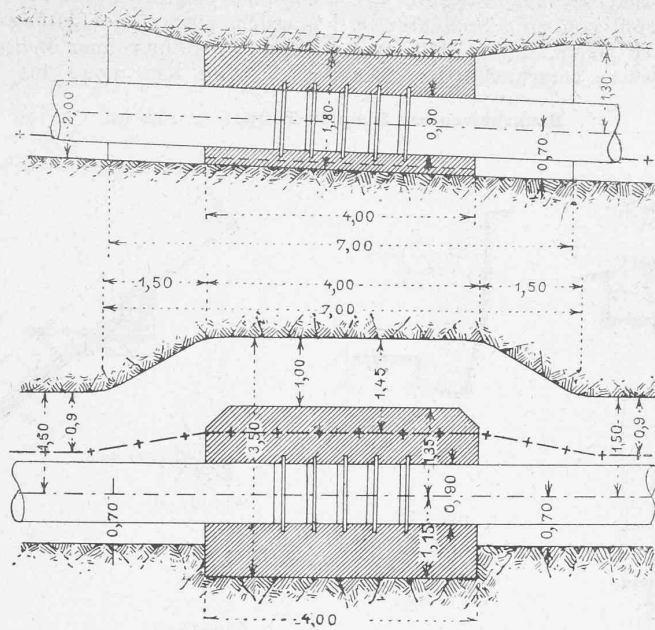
Wasserkraftanlage. — Druckleitung und Trinkwasserleitung (—+—). Verankerung im Stollen. Längsschnitt und Grundriss 1 : 100.
